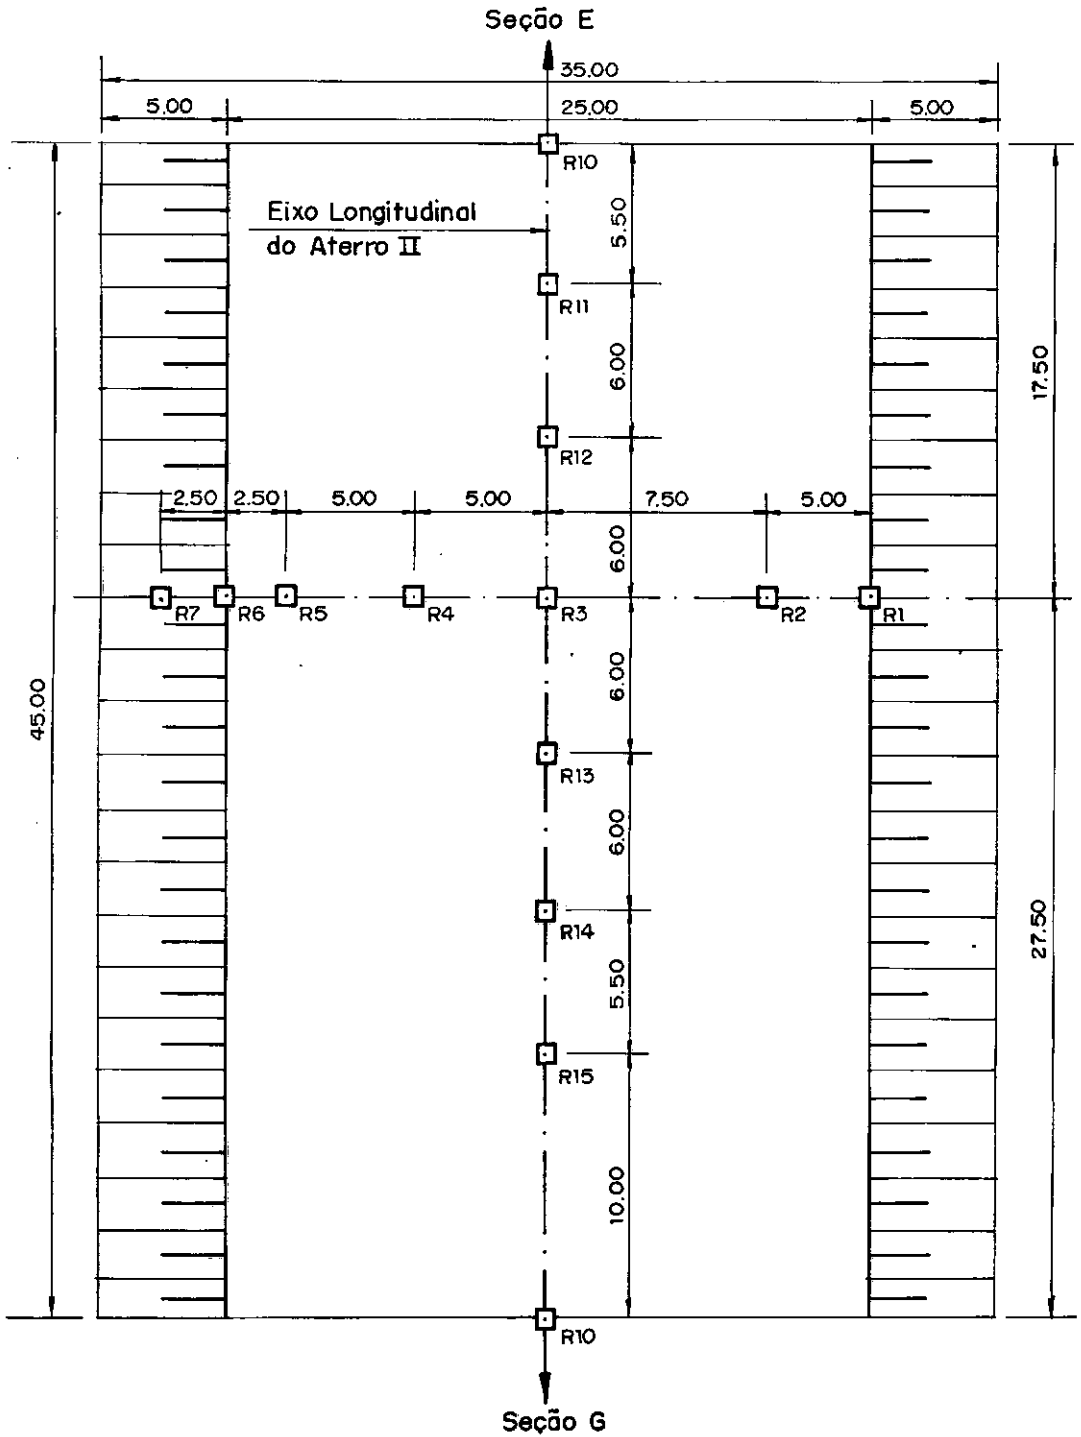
Localização das placas de recalque em planta - Seção F.
